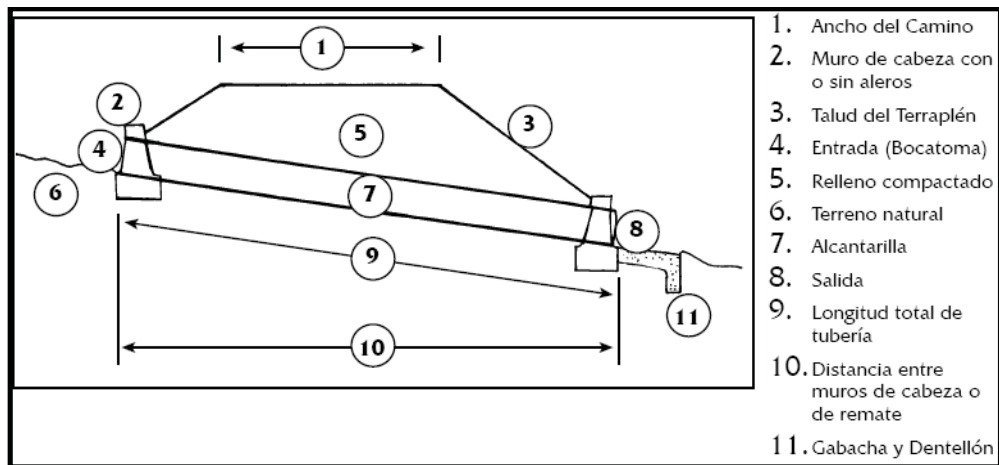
Alcantarilla tipo para una obra de drenaje.
